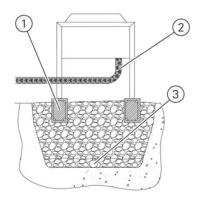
Installazione su letto di ghiaia e tubo di drenaggio
